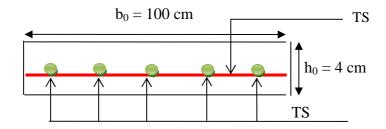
Schéma du ferraillage de la dalle de compression
